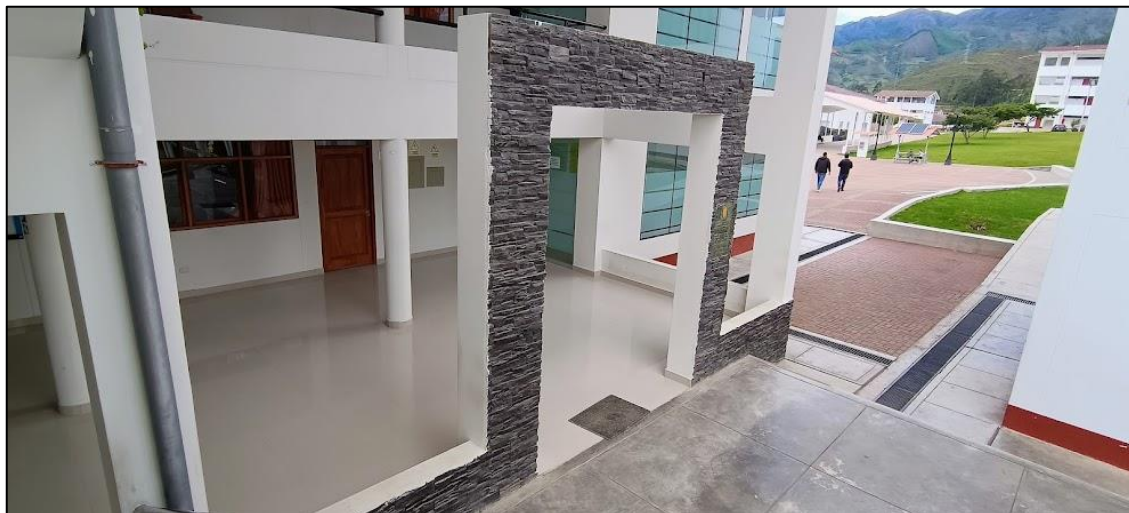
Vista de decoloración de fachaleta en fachada este.
